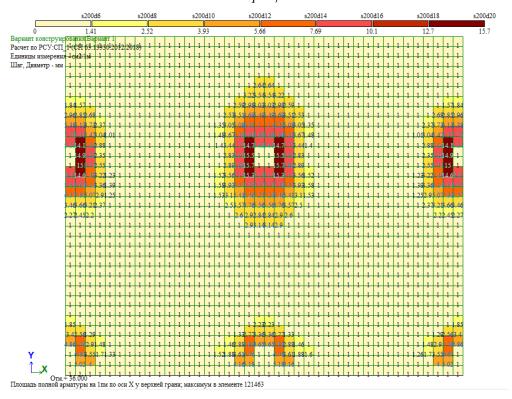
Требуемое верхнее армирование перекрытия по X после усиления двусторонним наращиванием
